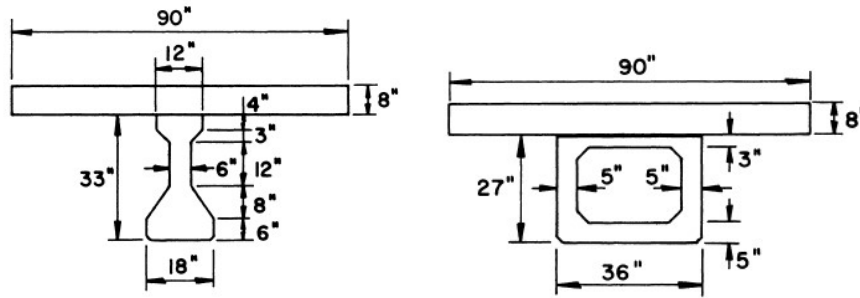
Seção das lajes betonadas sobre vigas pré-fabricadas, ensaiadas por Badoux (1965).
